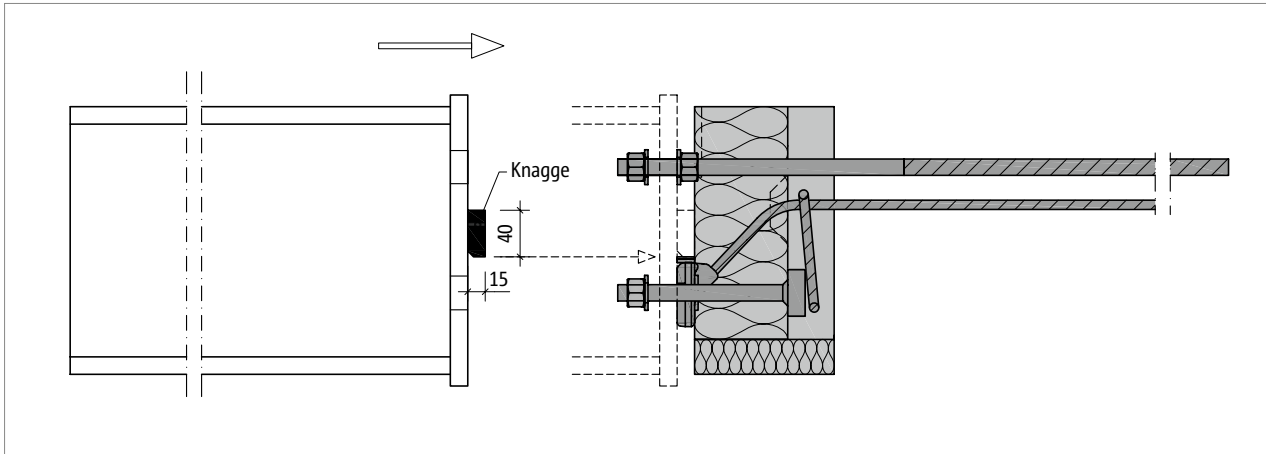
Schöck Isokorb® RT Typ SK: Montage des Stahlträgers
